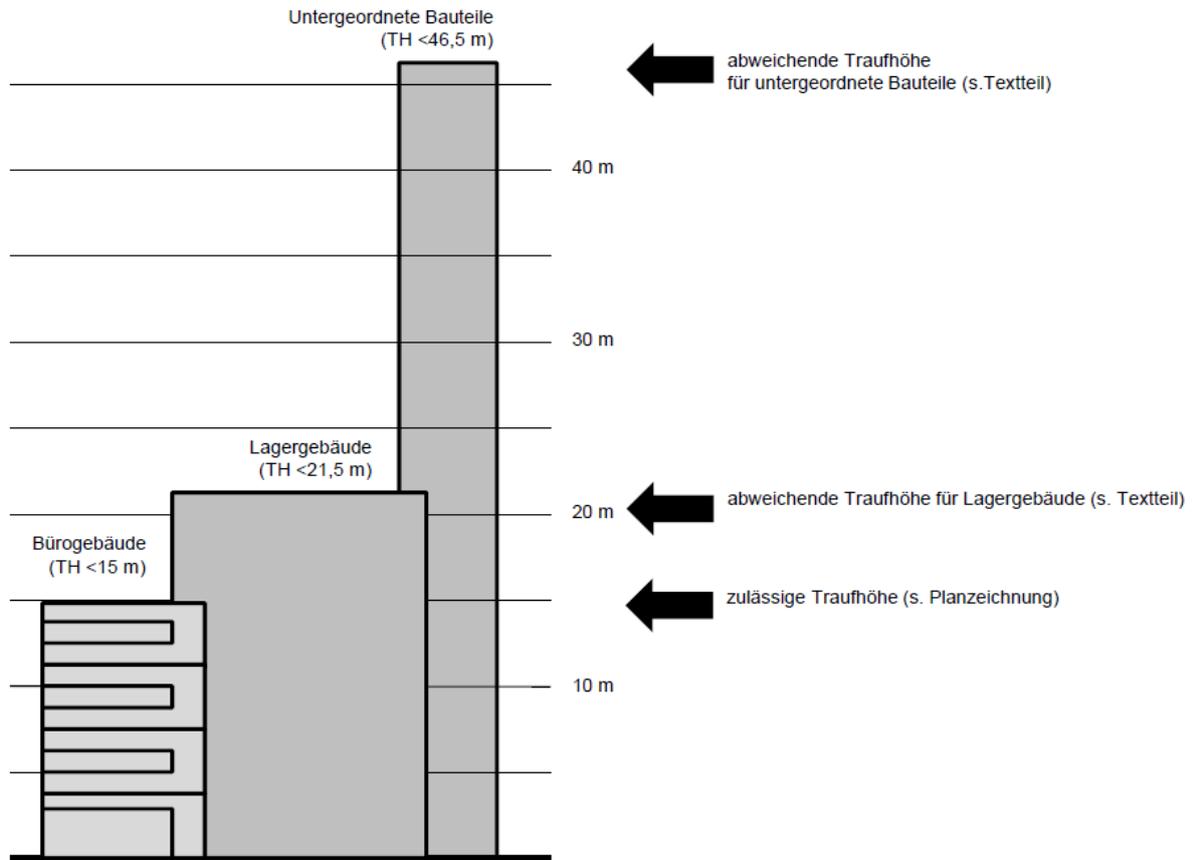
Darstellung der zulässigen Traufhöhen nach dem bisher geltenden Planrecht
